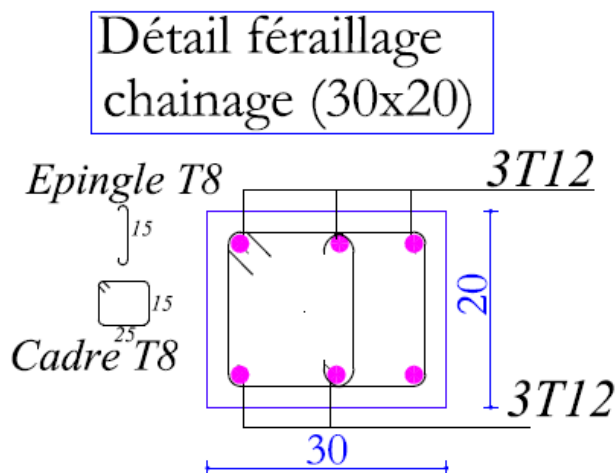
Schéma de ferrailage de la poutre de chaînage.
